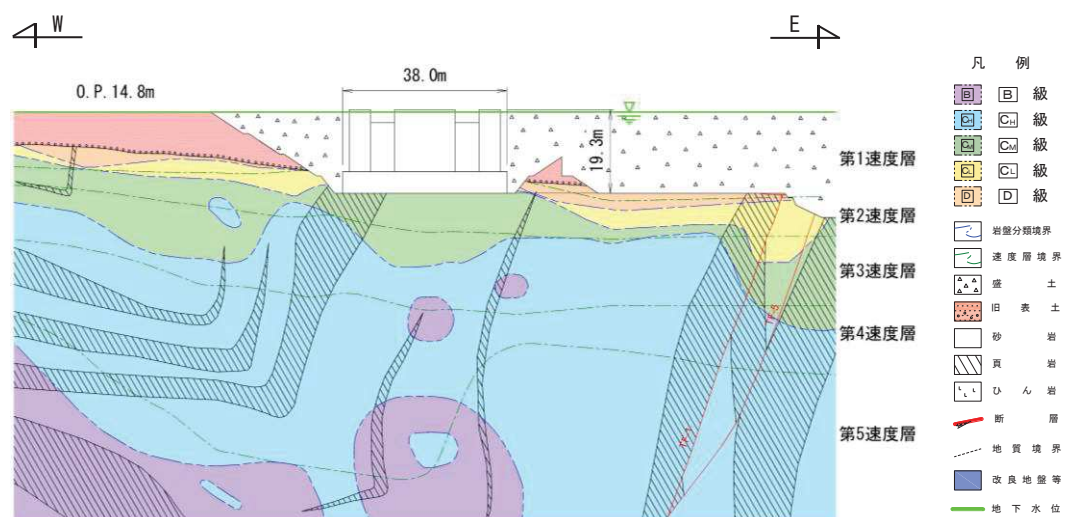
排气筒基础 地震时荷重算出用地质断面图 (EW 断面)
